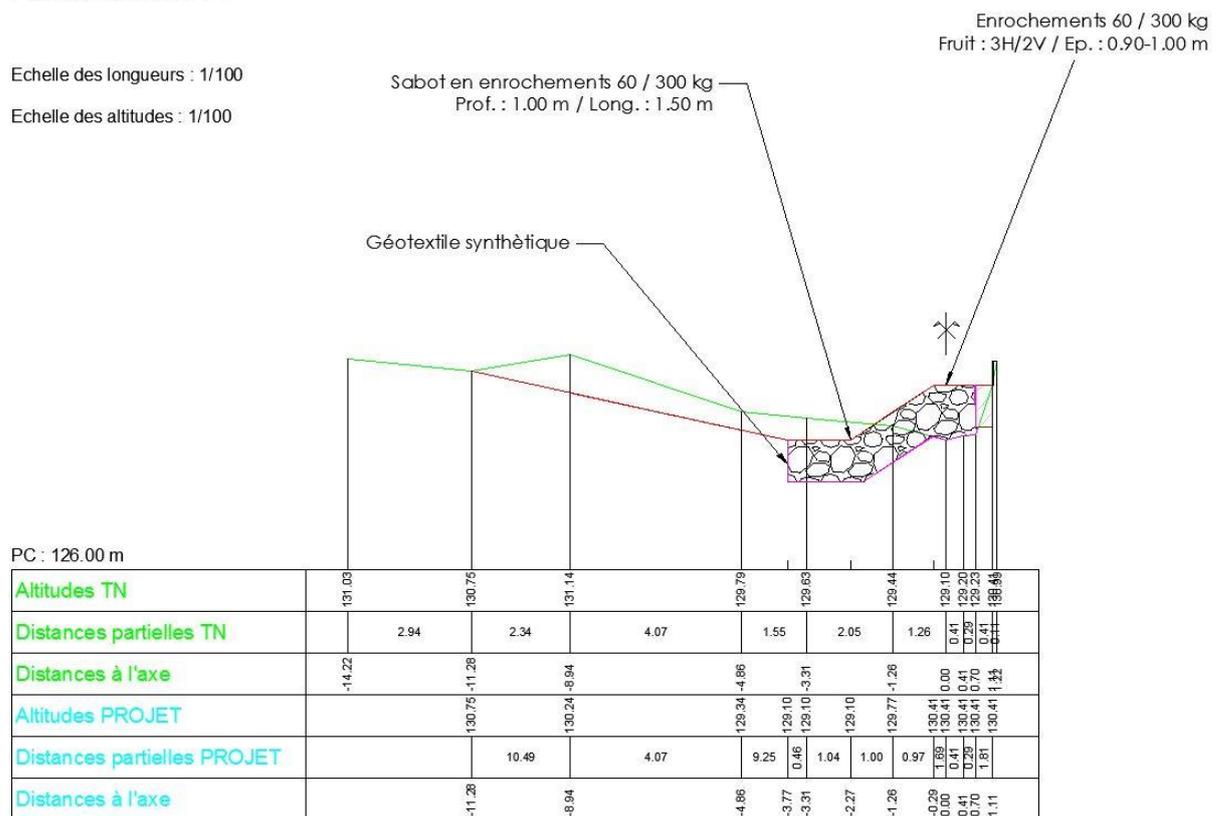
Coupe type de la protection de berge en enrochement - secteur aval
